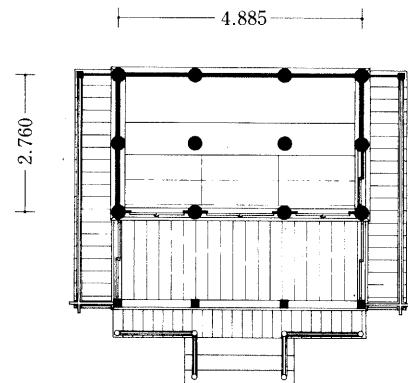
櫛代賀姫神社本殿 平面図 (1/150)
